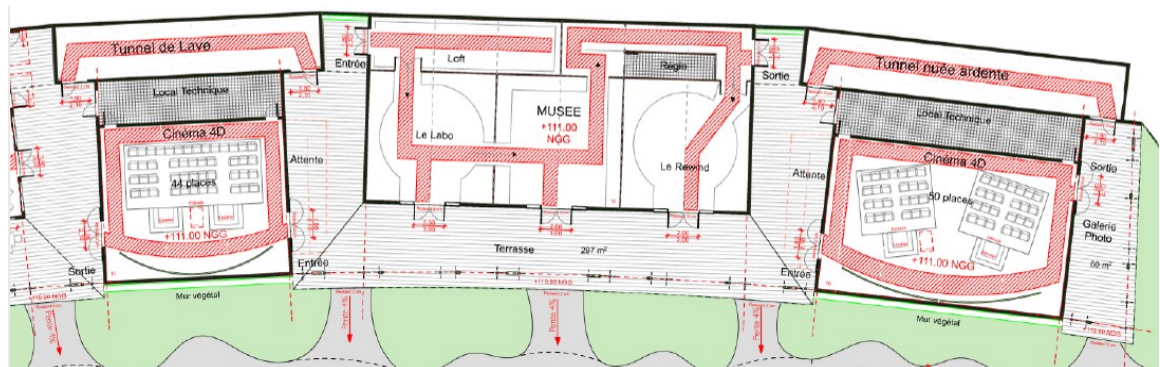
Plan de la zone ludique (source : SELARL d'Architecture Olivier Gros-Dubois)
